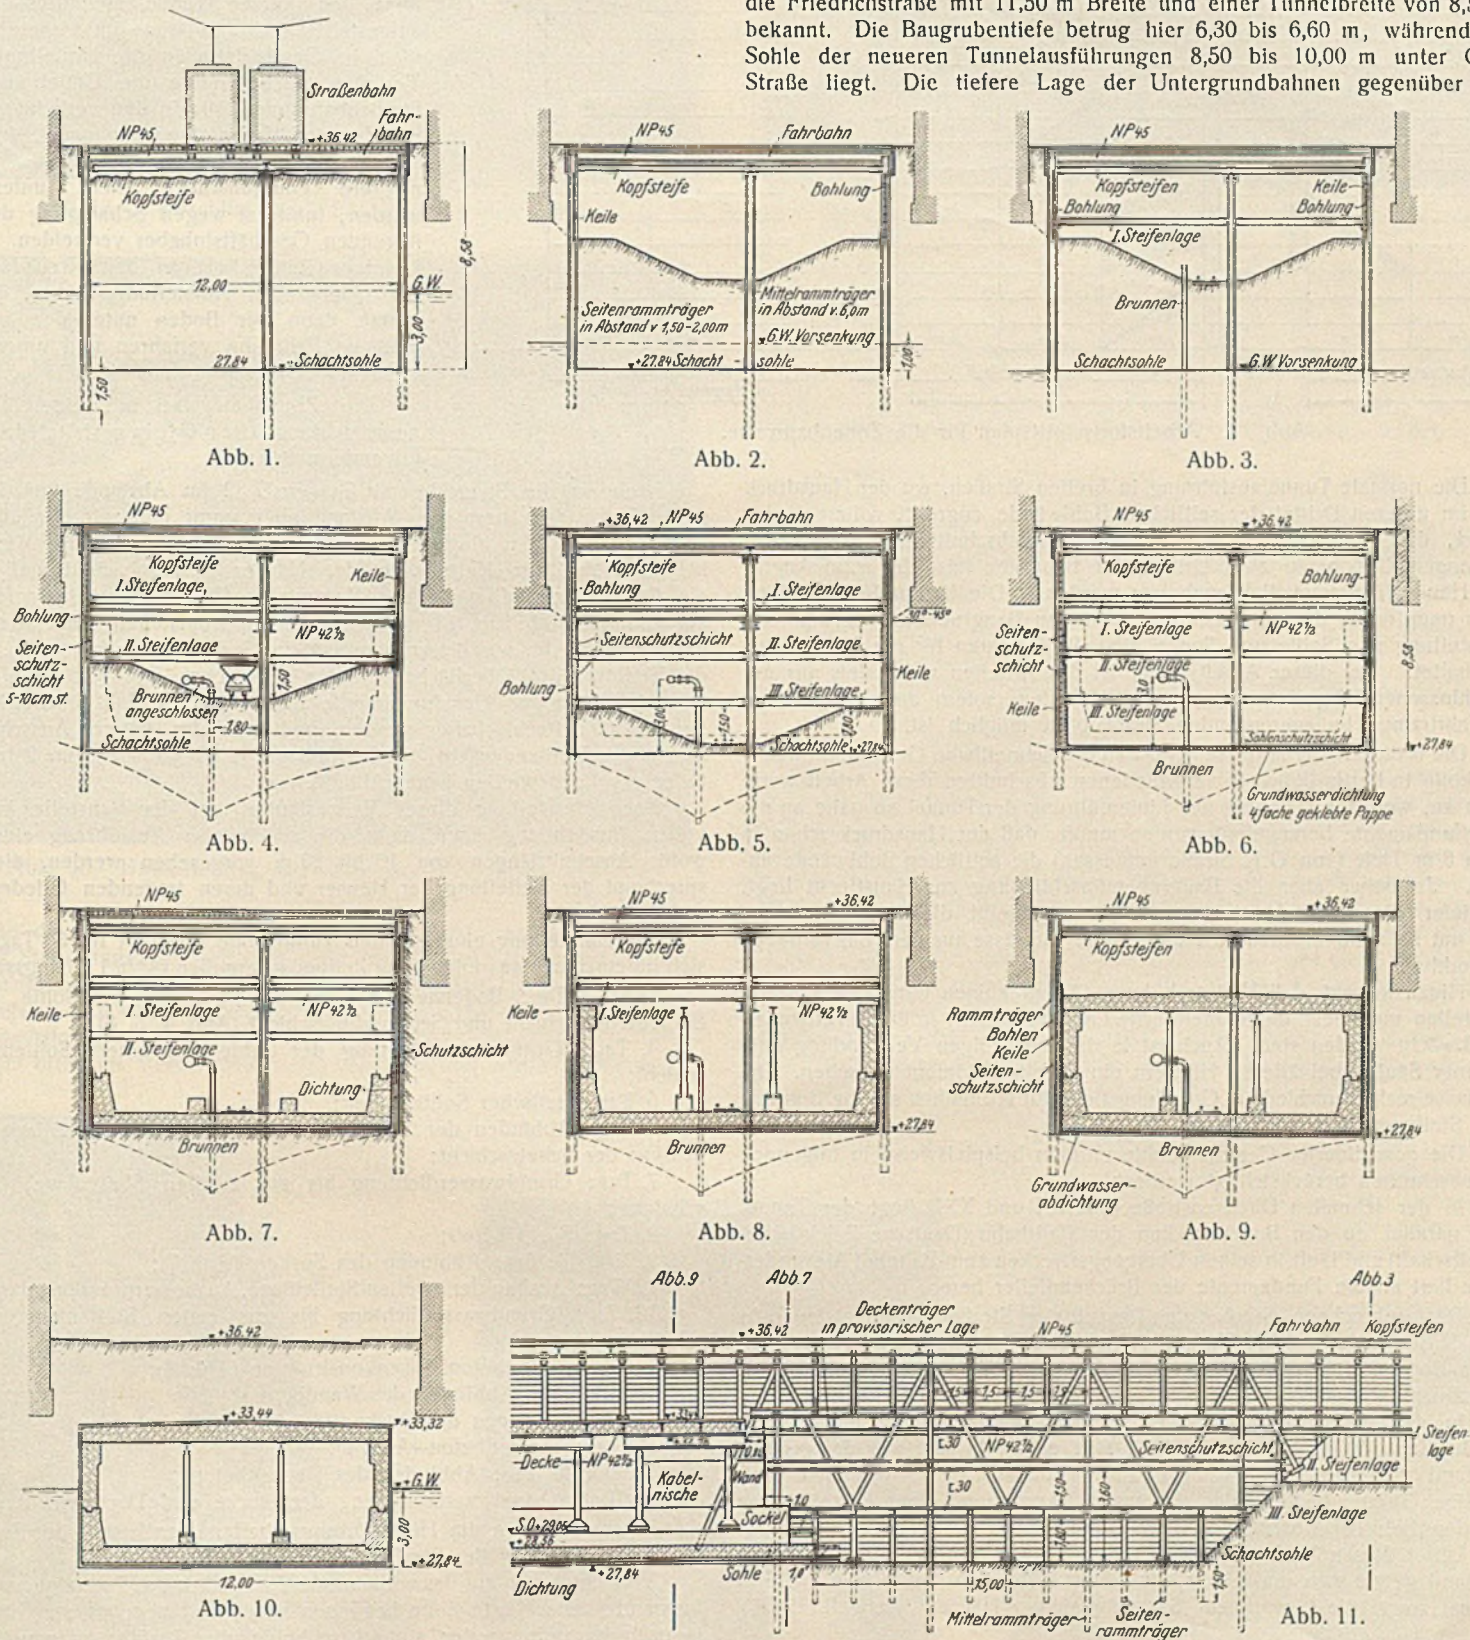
bis 11. Darstellung der Baugruben- und Tunnelausführung.
